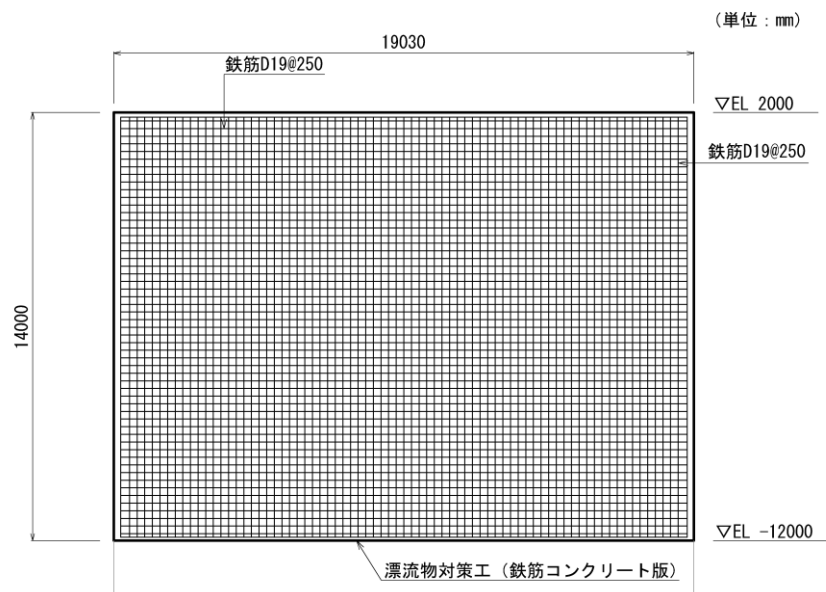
(3) 防波壁（波返重力擁壁）ケーソンにおける漂流物対策工（鉄筋コンクリート版）の概略配筋図（正面図）
